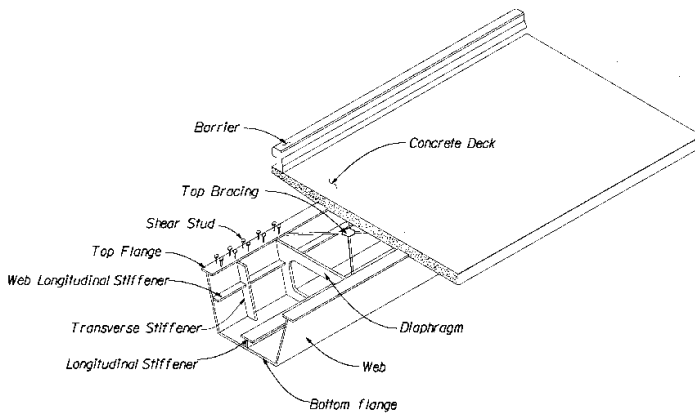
Tipikal penampang melintang dari komposit box girder
